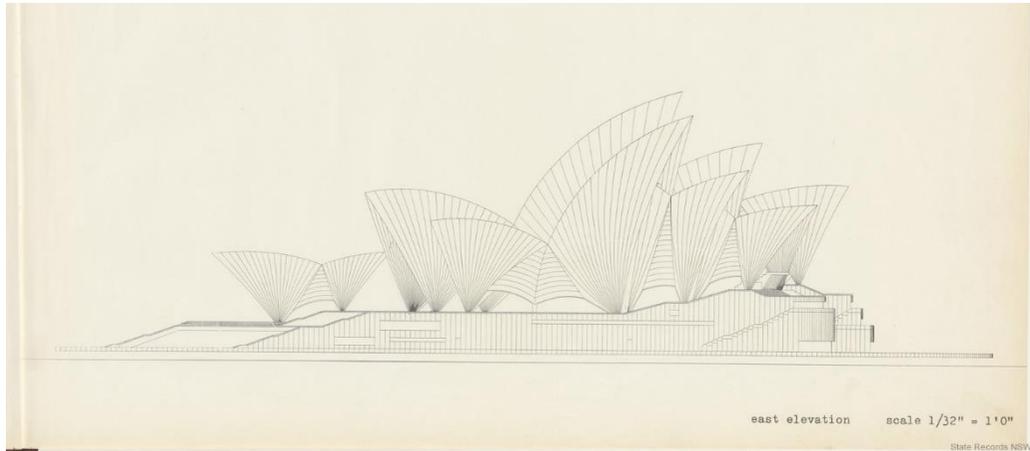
Disegno di prospetto tratto dal *Yellow Book* - Disegni di concept per la forma delle volte. © The Sydney Opera House Trust.
